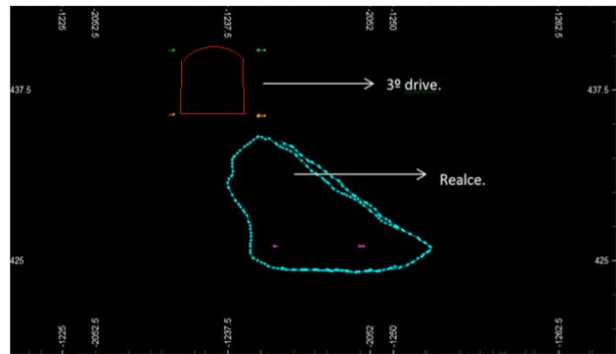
Pilar entre Realce e galeria onde foi instalado o SMDR
